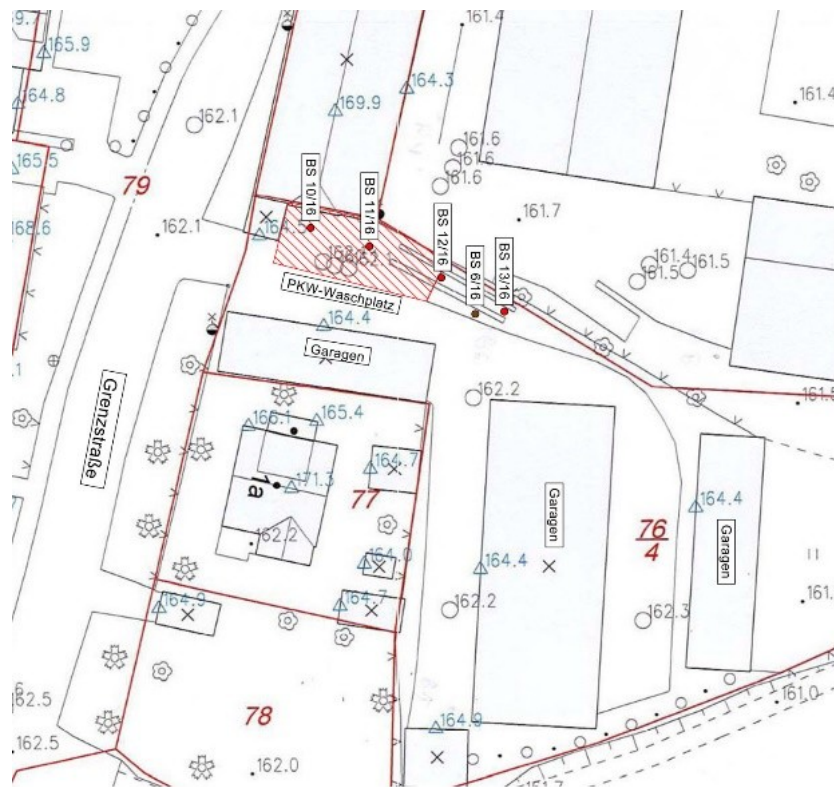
Lage- und Aufschlussplan (Quelle: Geotechnische Stellungnahme der BEB Jena Consult GmbH vom 07.12.2016)
